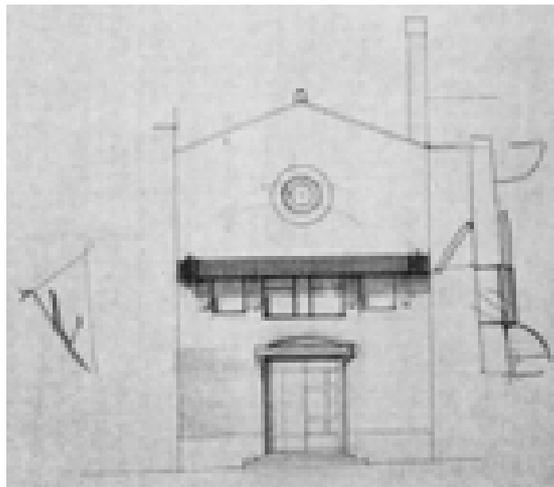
Studio prospetto - s.d. (AABS-94.091)
